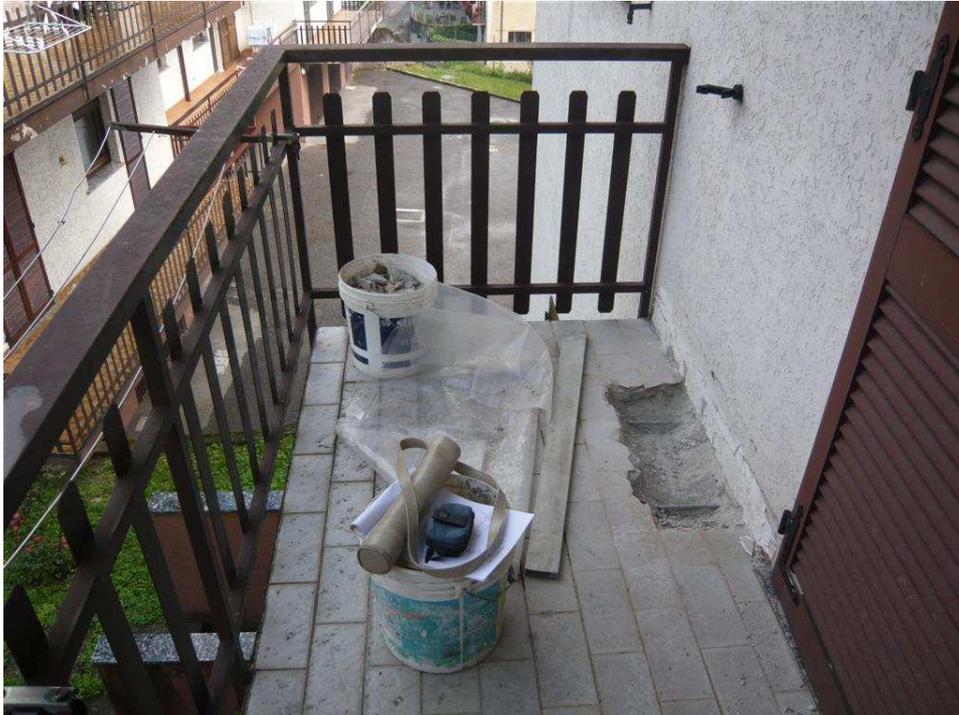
Balcone ovest – estradosso: rilievo delle armature
